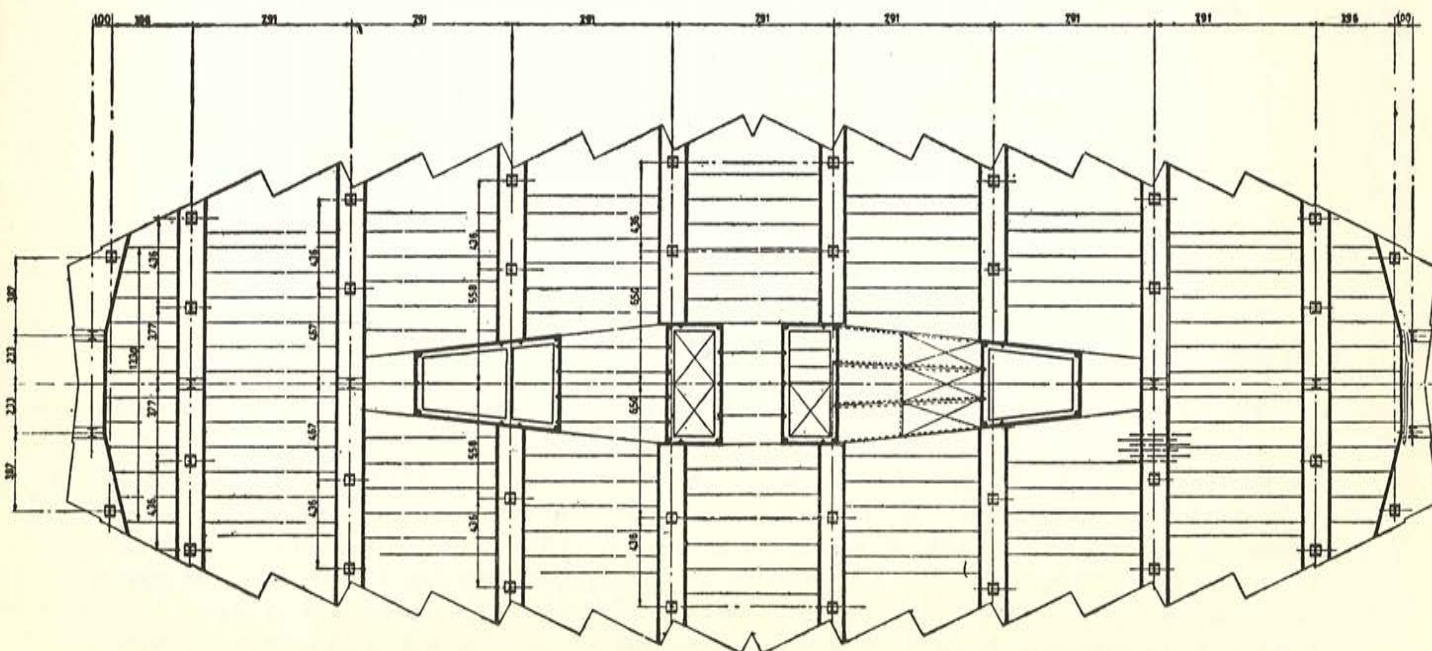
Disposición en planta de las losas de forjado y las vigas de arriostamiento en una planta tipo.
